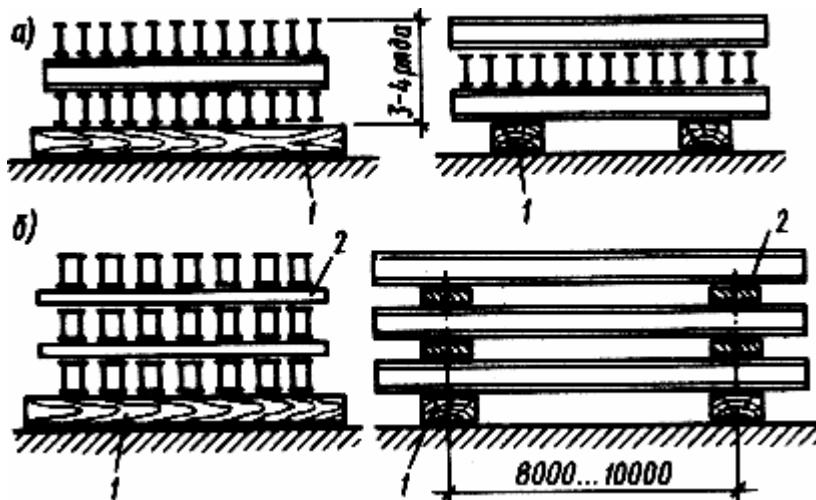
Складирование стальных элементов конструкций в многоярусных штабелях:
